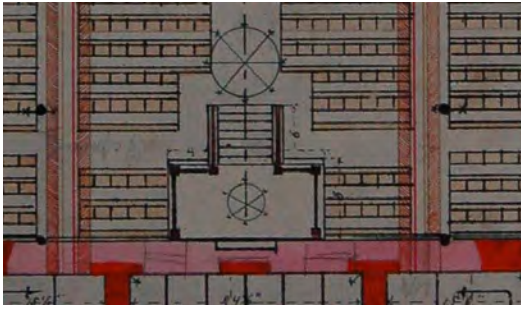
Planmaterial Ausschnitt Grundriss
